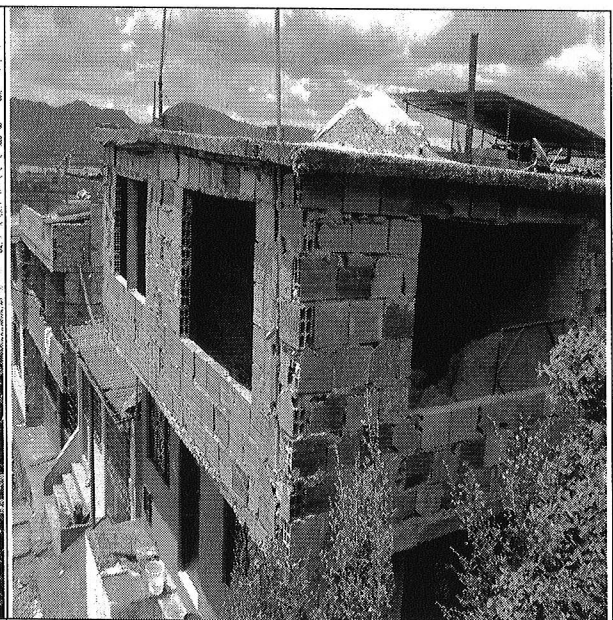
Aspecto de la placa de entpiso en concreto reforzado, se observa que el refuerzo no presenta un adecuado recubrimiento. Vista desde el primer nivel secto de fachada *(Fotografía tomada el 21 de Febrero de 2009)
